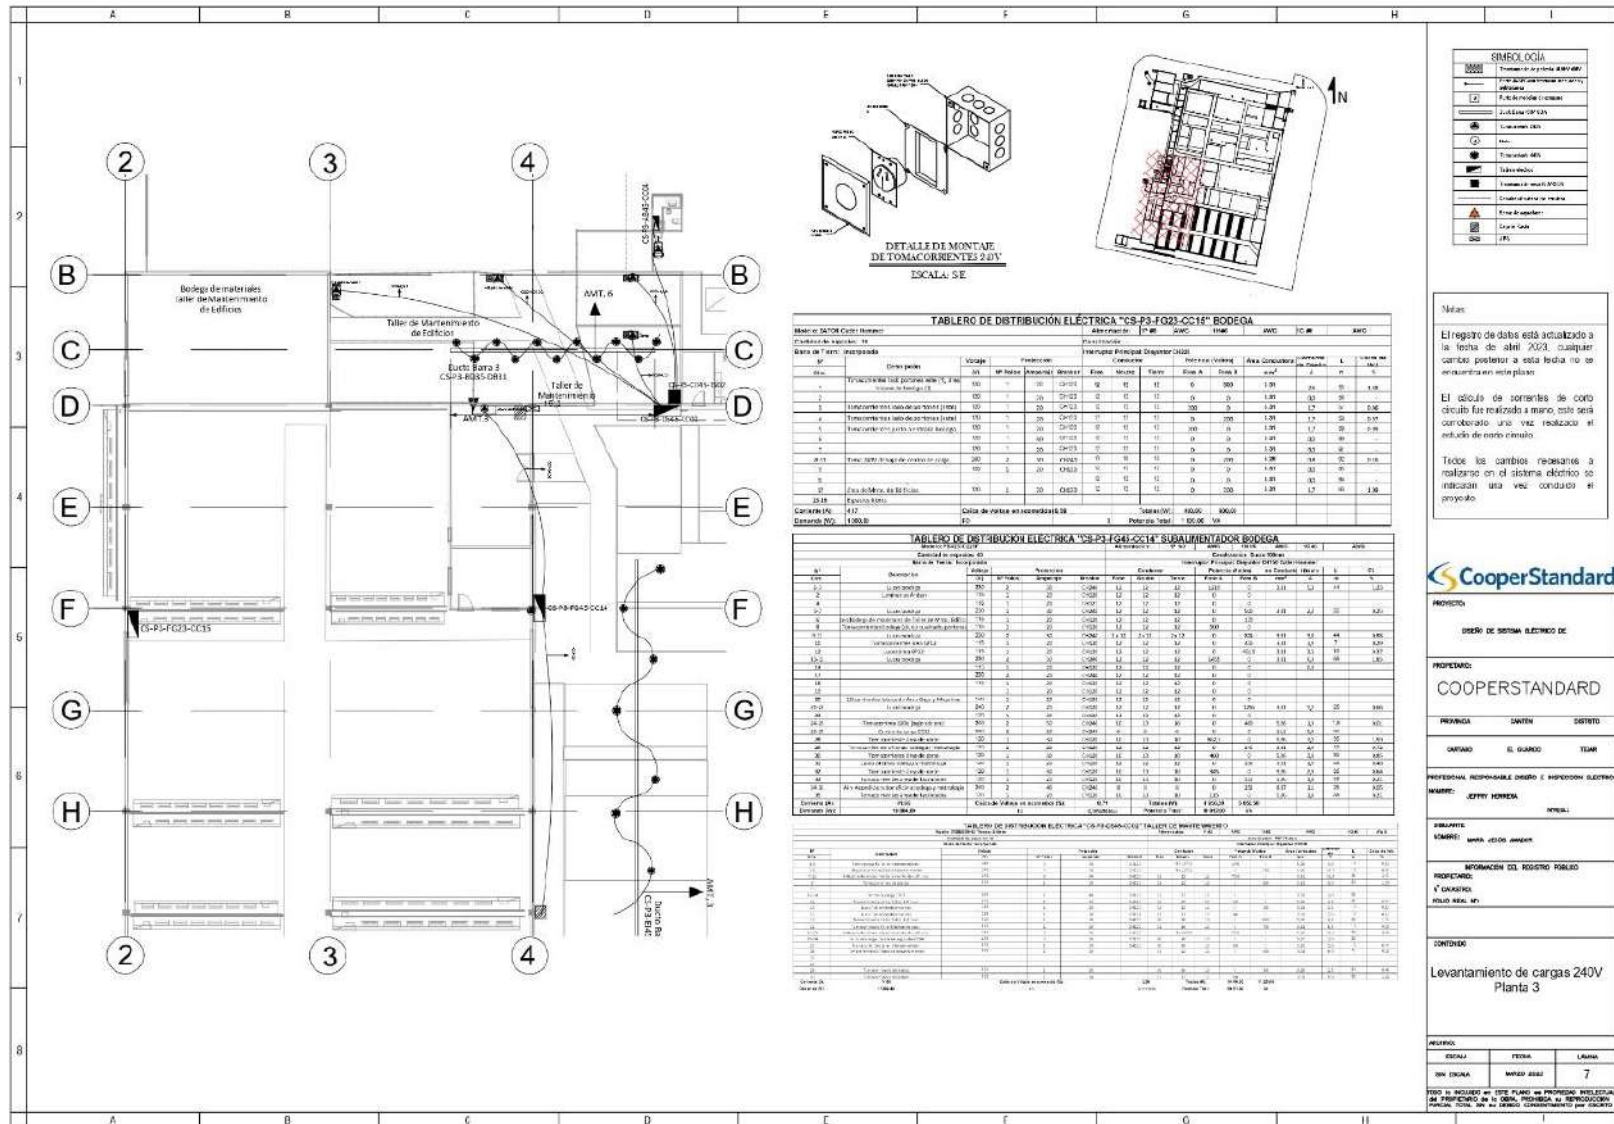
Cargas especiales a 240V, Planta 3 Fuente: Elaboración propia, realizado en AutoCAD (2023).
